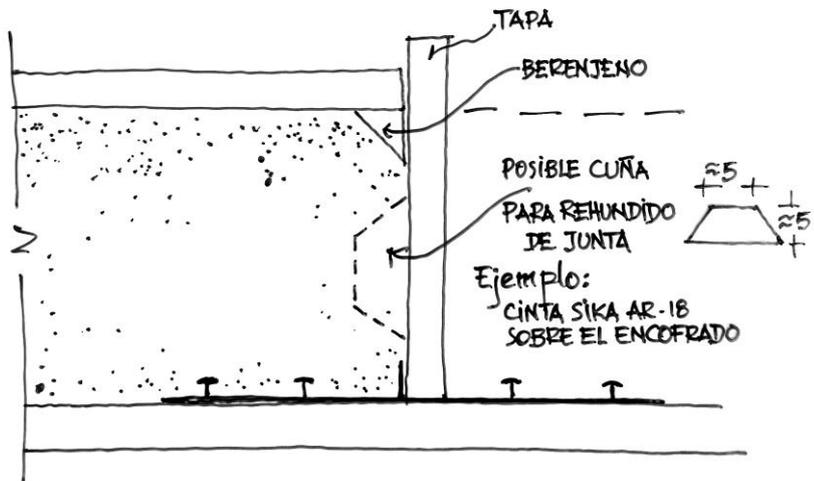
Esquema de junta de retracción de hormigonado de muro in situ con cinta superficial de PVC
